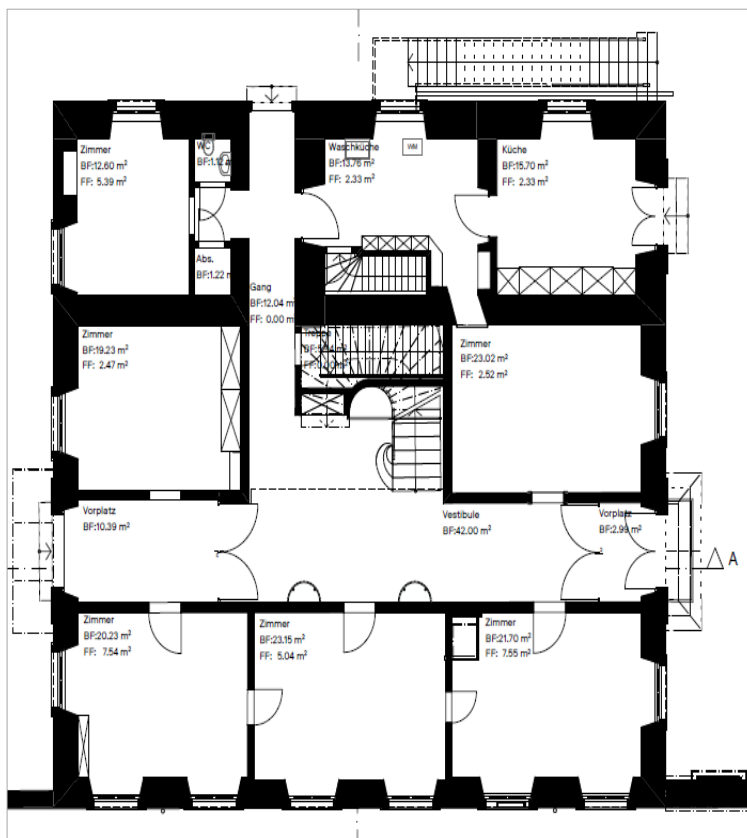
Grundriss Obergeschoss Liegenschaft Generalengut
